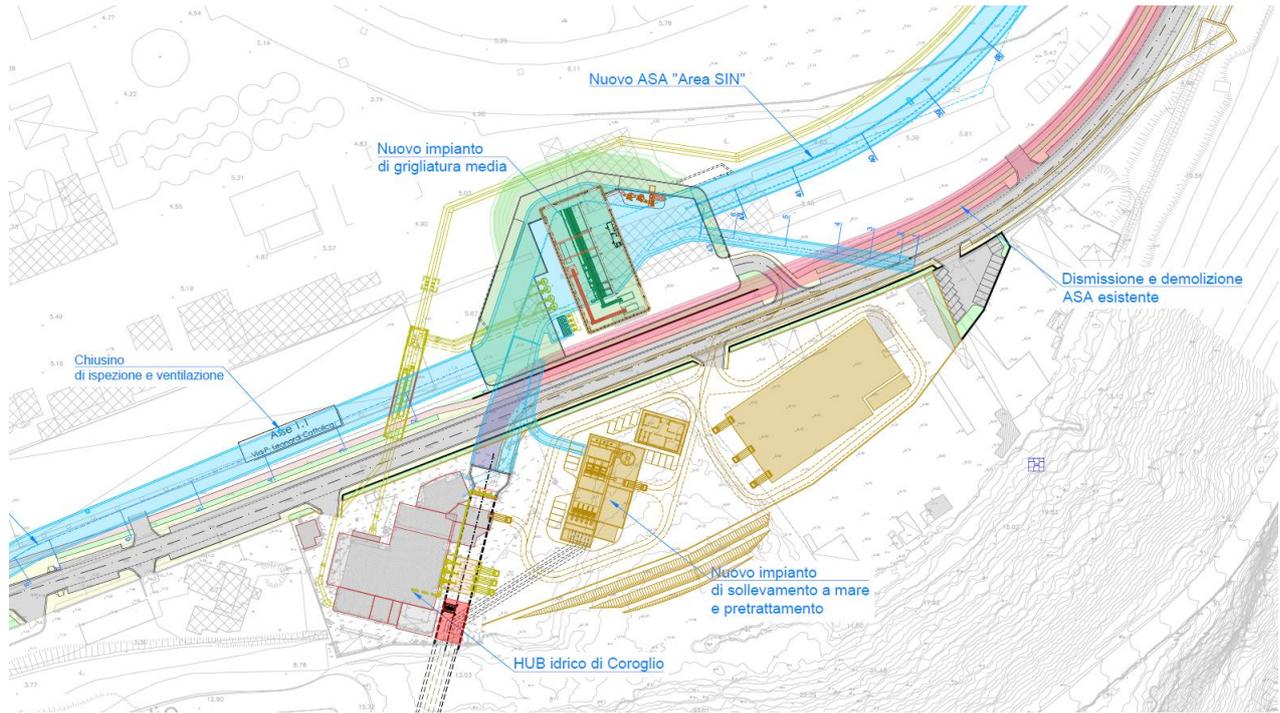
Stralcio planimetrico di alcune delle principali opere idrauliche previste
